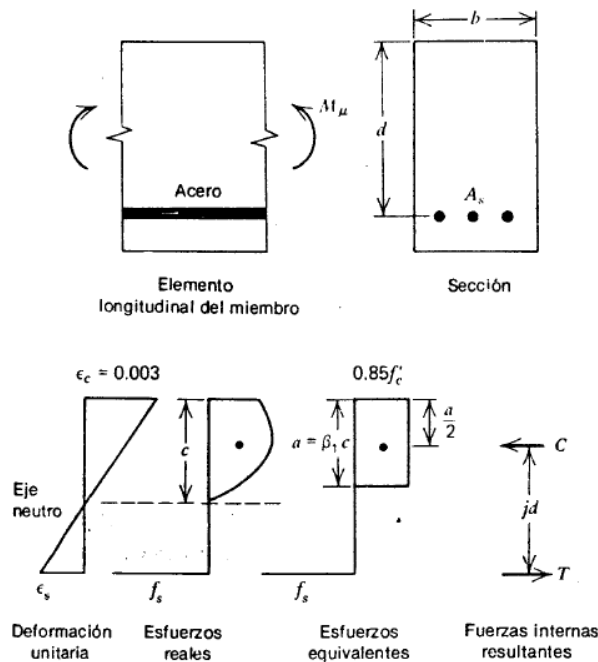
Sección de hormigón simplemente armada cuando se alcanza la resistencia a la flexión (Fuente: R. Park & T. Pauley)
